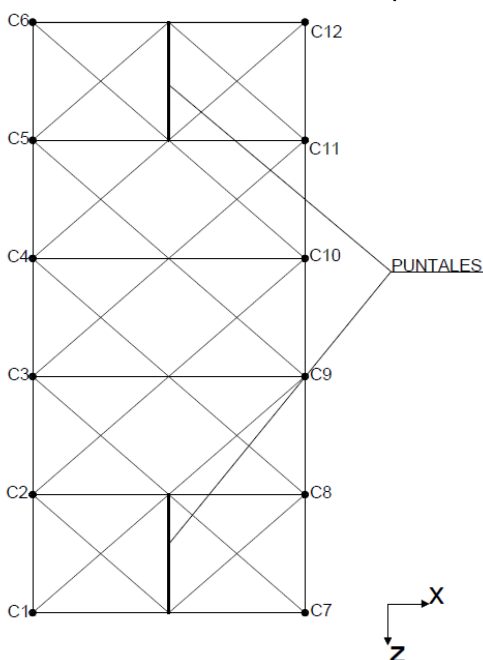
Vista en Planta-Se muestra la Ubicación de los Puntales
